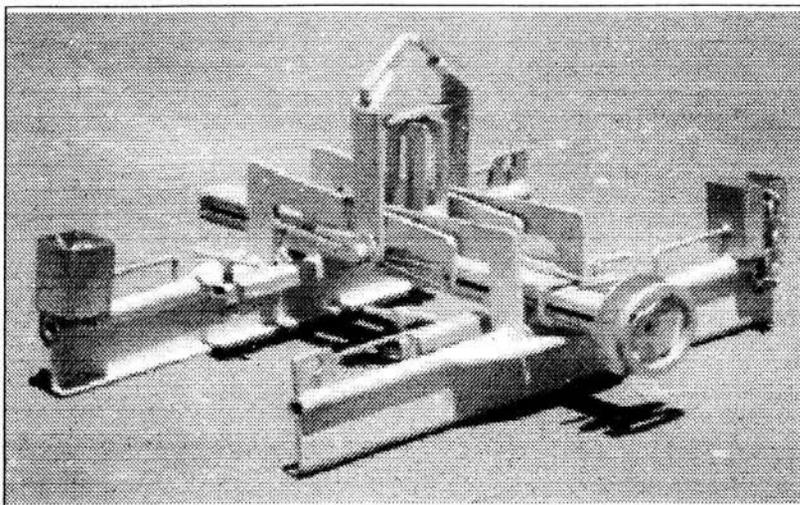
Se muestra en la figura la herramienta (tenaza) necesaria para sujetar paneles de losas de entepiso y azotea, la elevación de los paneles se hace con la ayuda de una grúa, el rendimiento de la colocación de piezas depende del espacio que se tenga para maniobra de la grúa.
